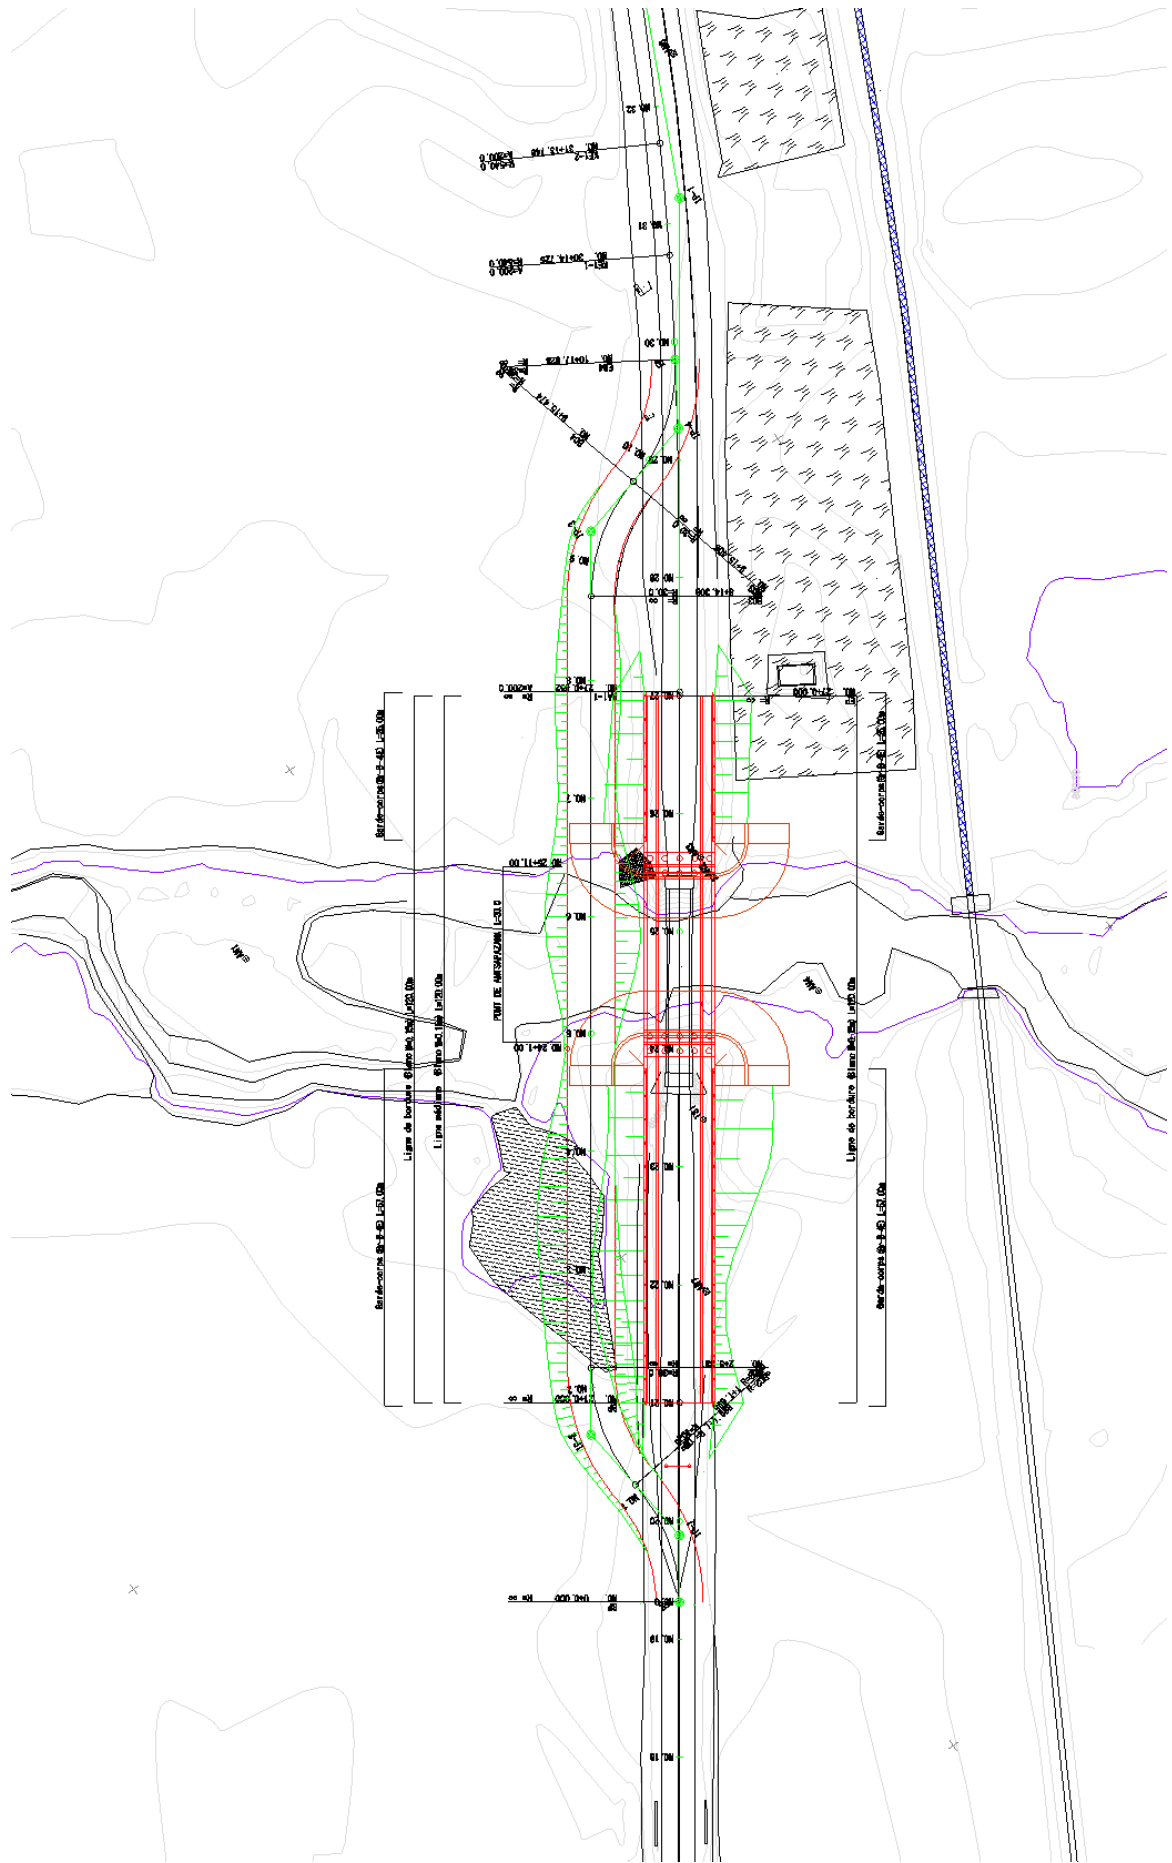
Plan général de la déviation du pont d'Antisapazana
